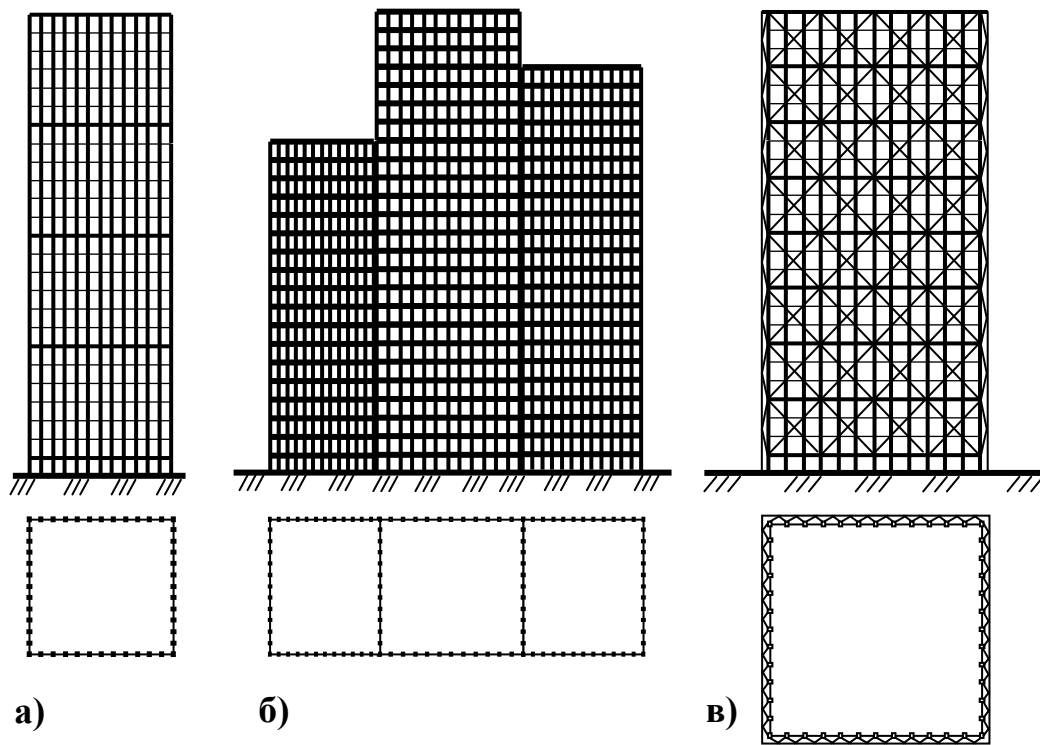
Схеми будівель підвищеної поверховості оболонкової системи:
